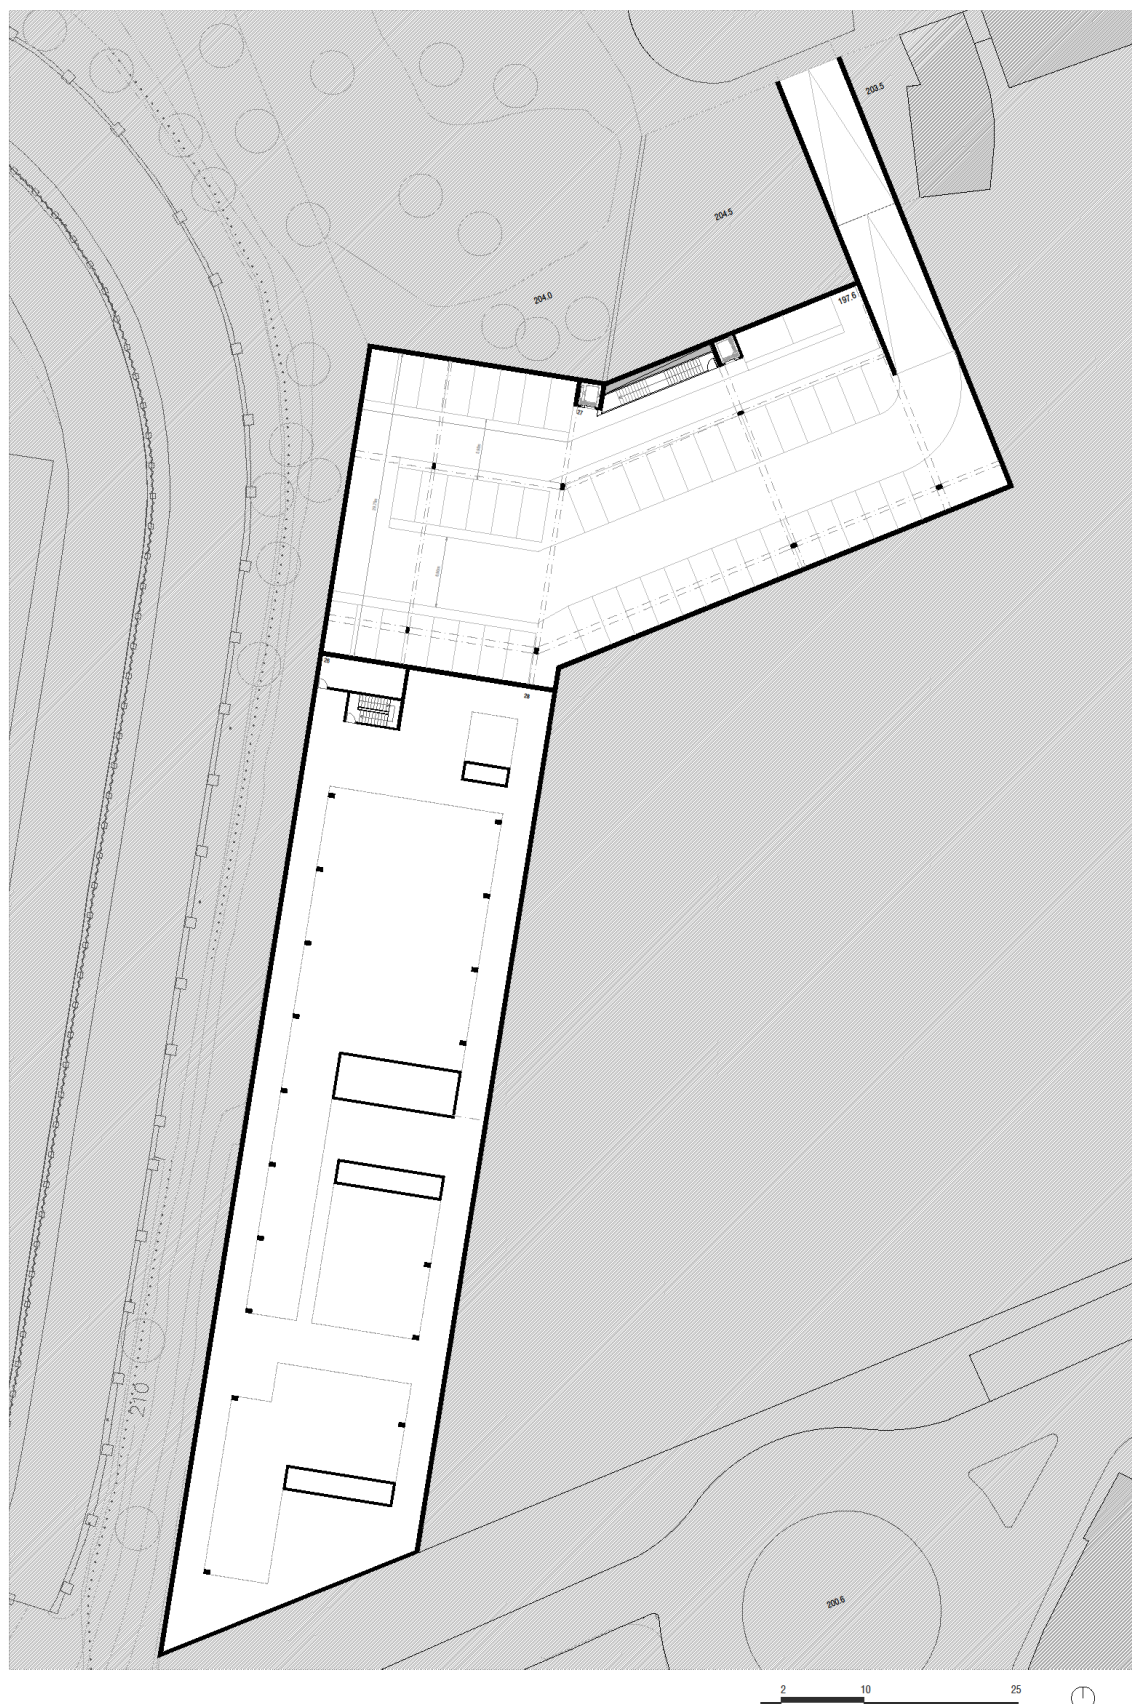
Proposta: Planta Piso -1, Fonte: Autor
